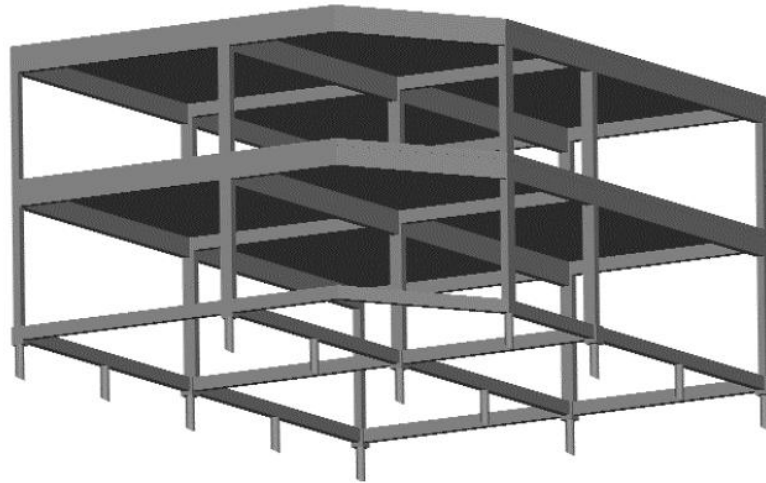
Perspectiva da estrutura composta por lajes, vigas e pilares.
